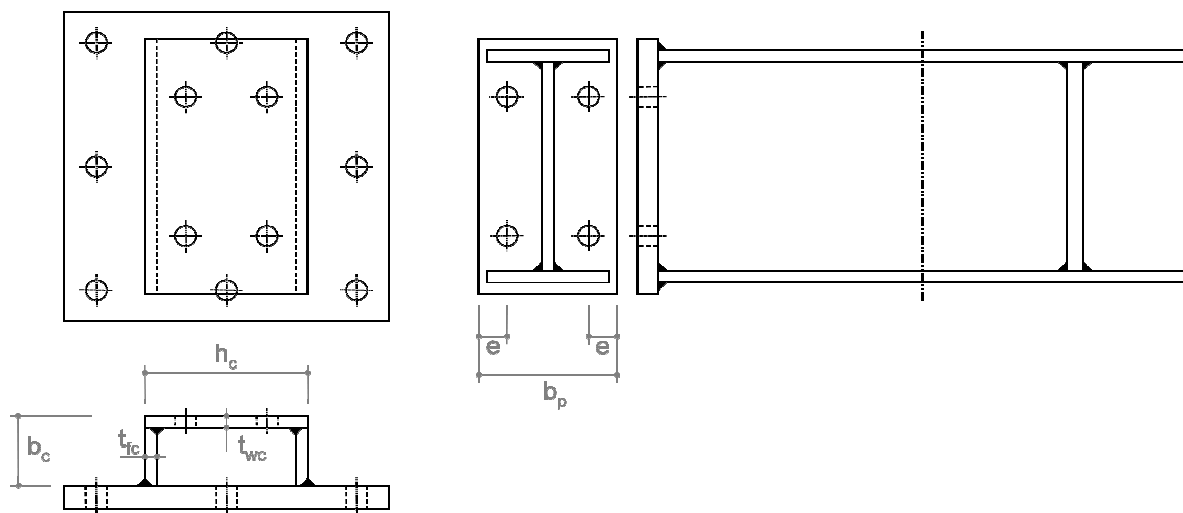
Esquema do perfil em U e da viga de aplicação do carregamento
